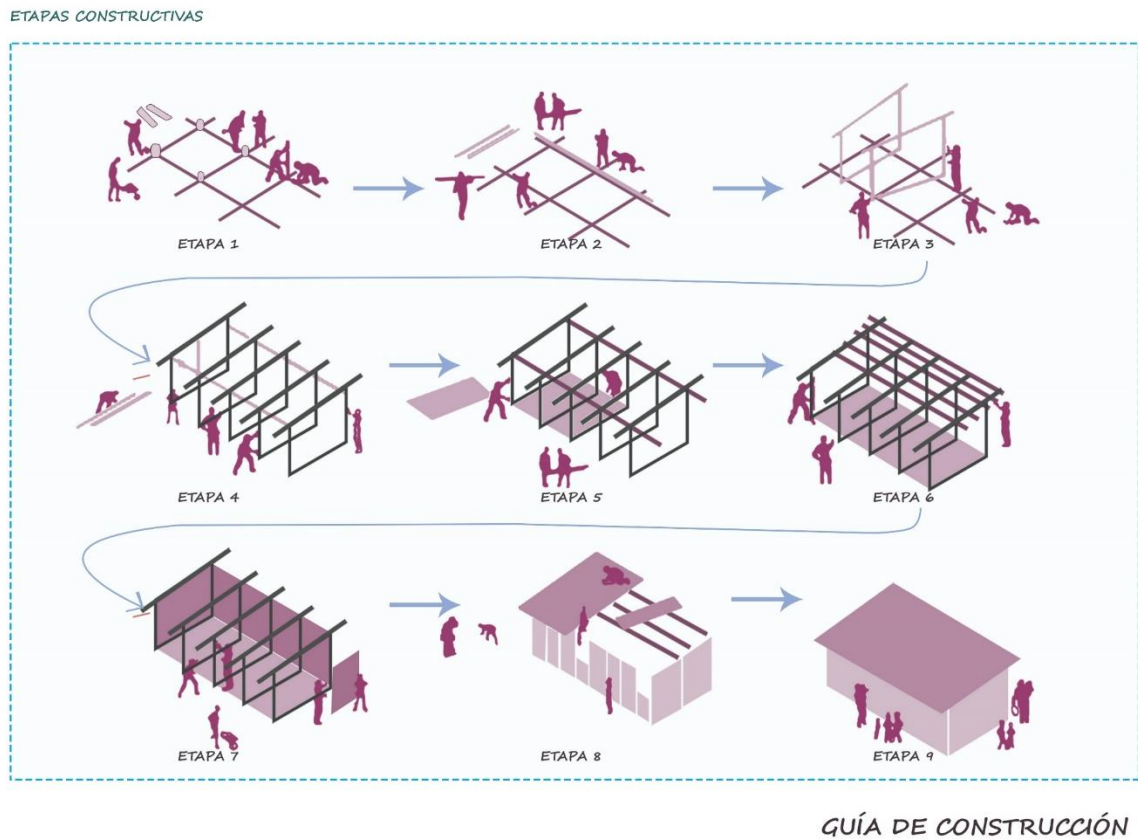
Detalles constructivos. (Fuente: Elaboración propia)
